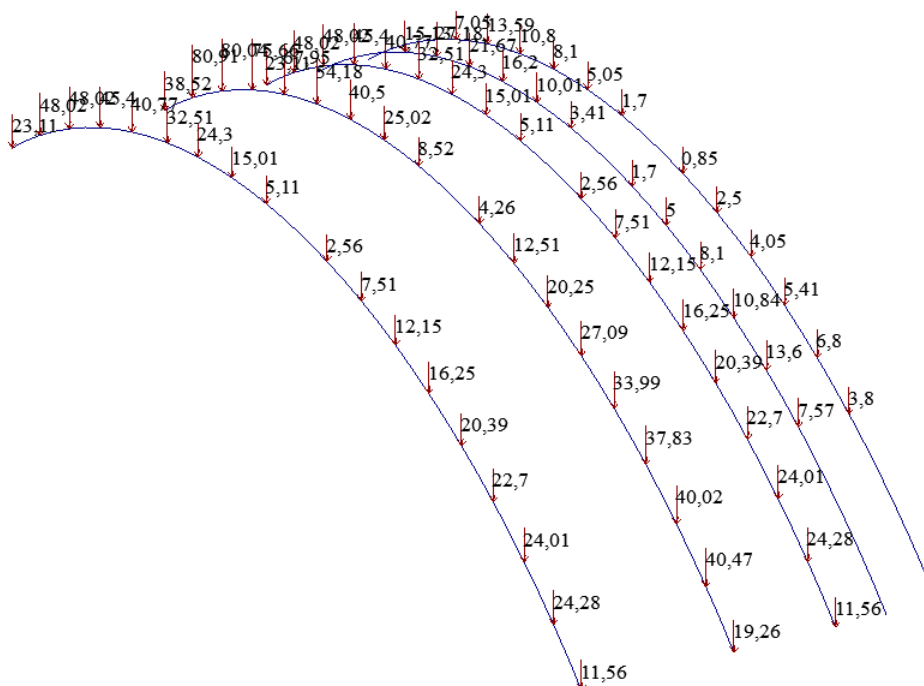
Схема приложения снеговых нагрузок на арочное покрытие блоков Г и Д (вариант 2)
